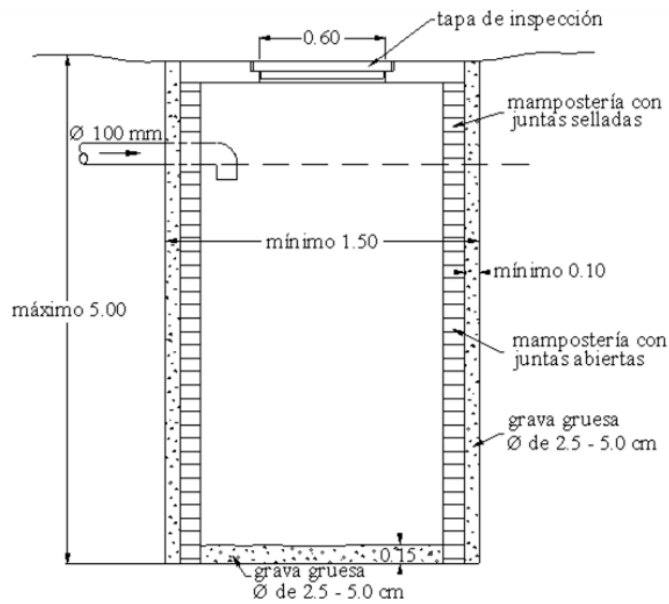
Pozo de absorción/infiltración Construido in-situ⁴⁸
